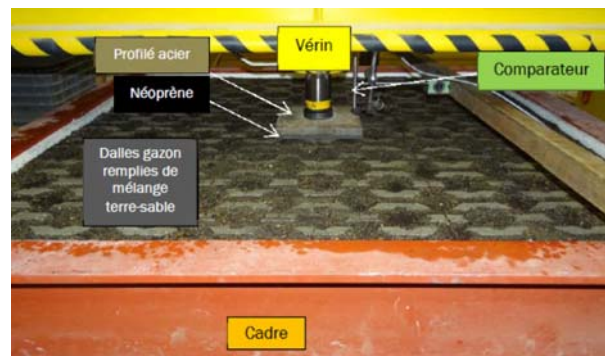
Essai sur dalles drainantes de type « dalles gazon » en conditions de pose
